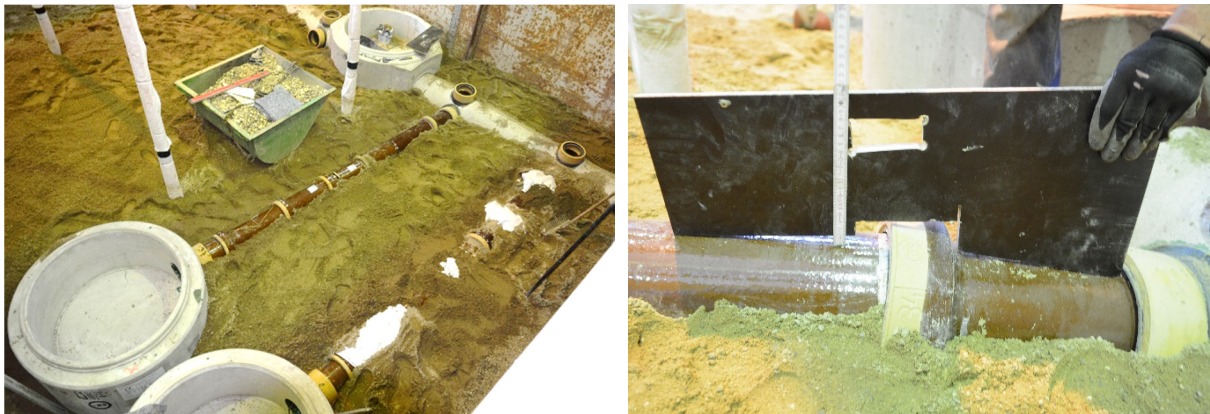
Einbau der unteren Rohrlage: Draufsicht mit Anschlussschacht und Hauptleitung (links) und Schablone für den Einbau des Schadensbildes „Abwinkelung“ (rechts)
